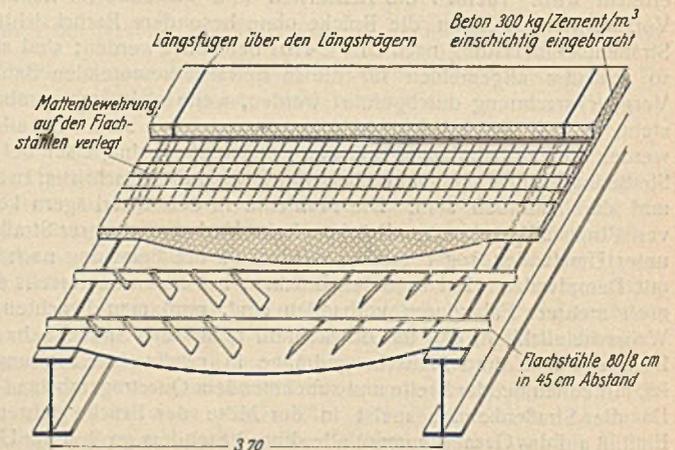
Leichtfahrbahn mit aussteiften Tonnenblechen.
